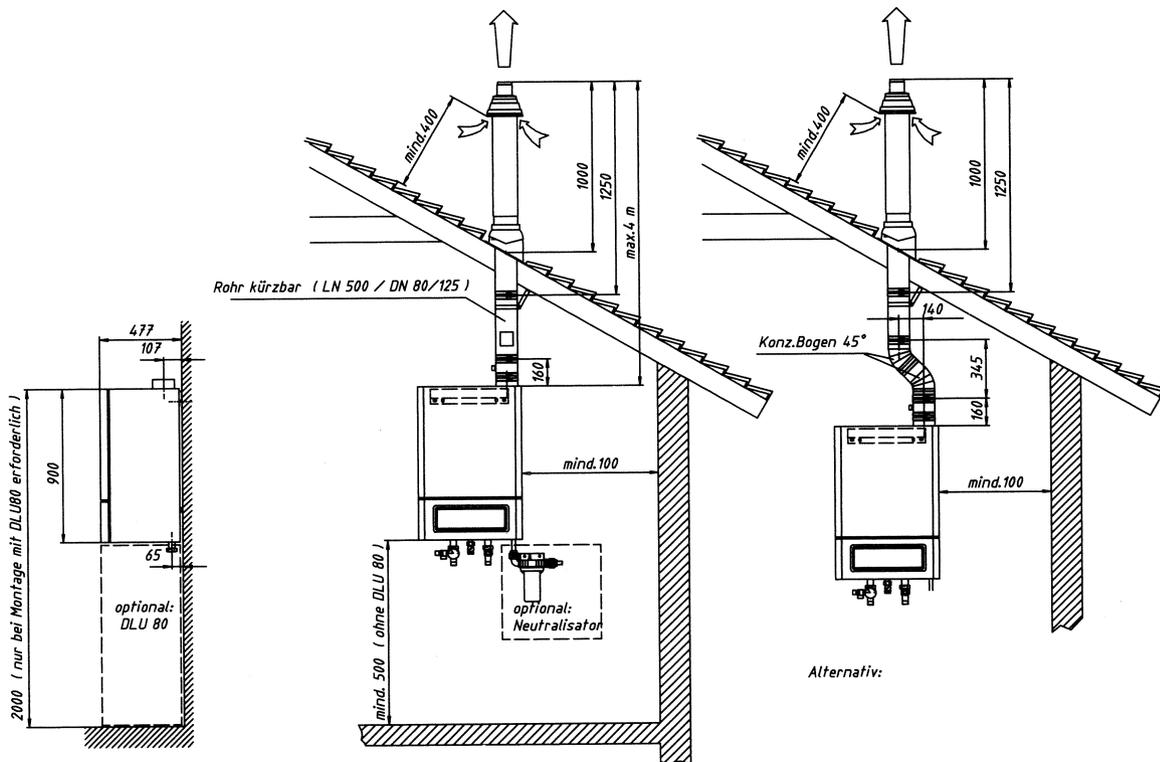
Einkesselanlage in Gebäuden, raumluftunabhängig als senkrechte Dachdurchführung
